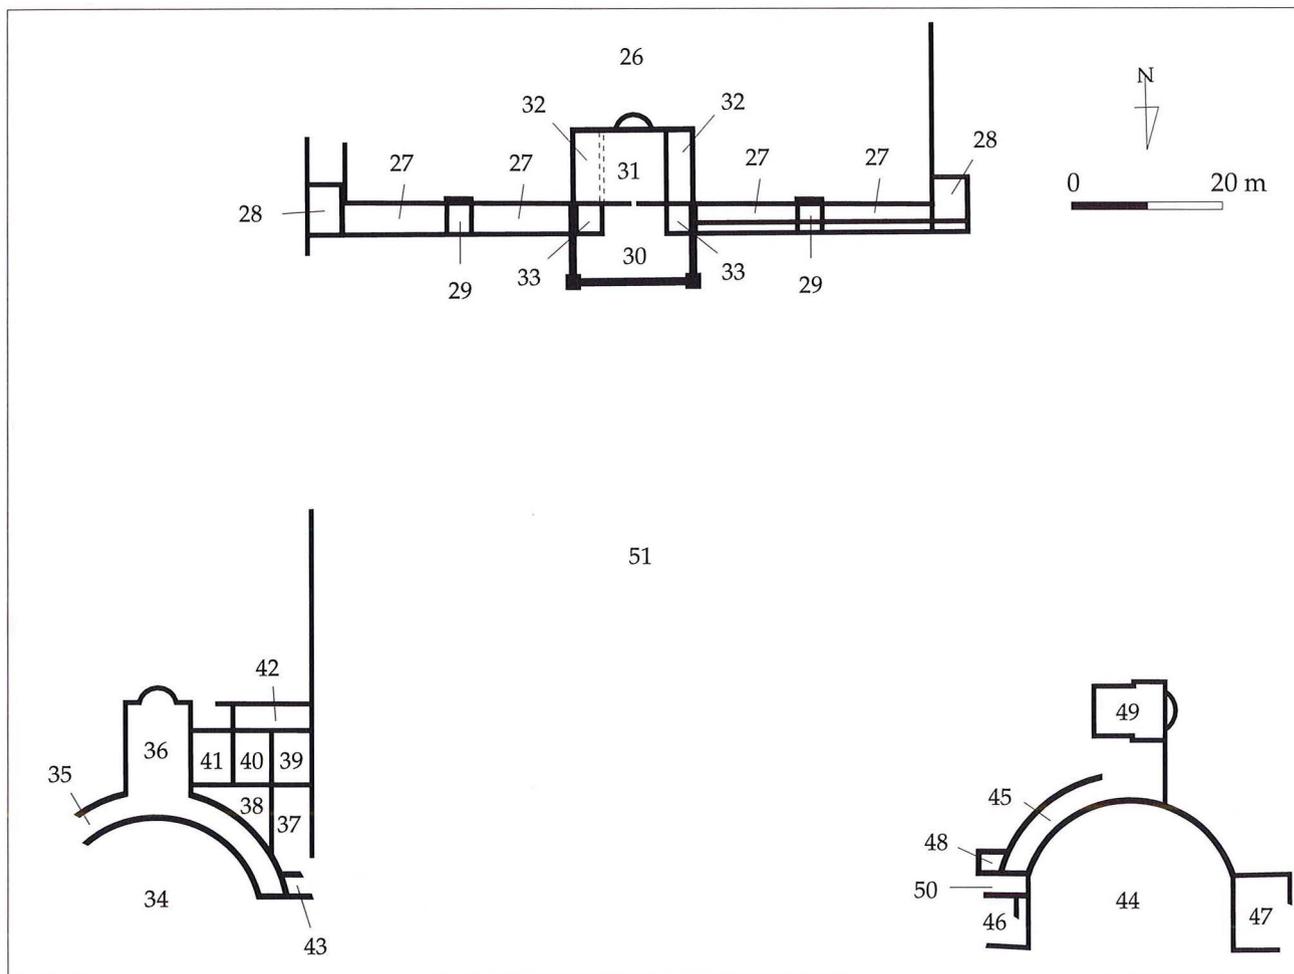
Chamiers : plan de la zone centrale (d'après plan Ch. Durand, Service Régional de l'Archéologie, Bordeaux).
